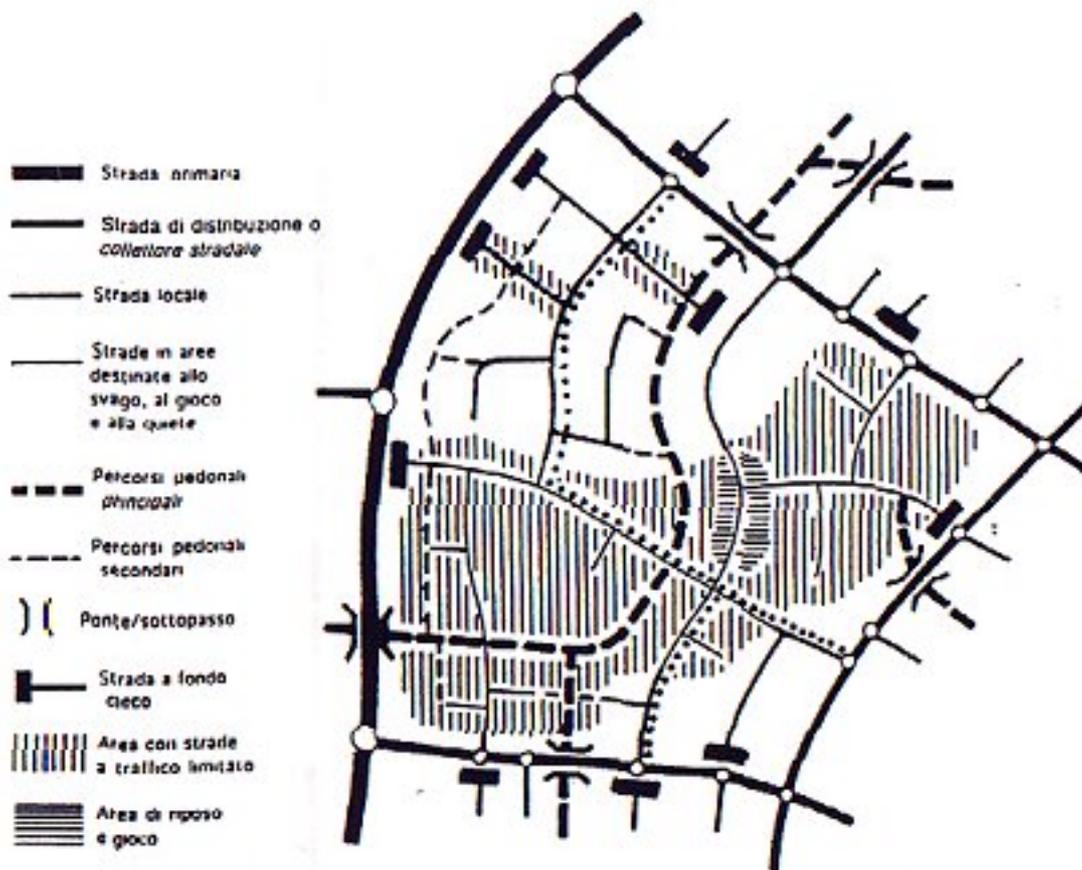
Assetto di rete stradale gerarchicamente strutturato con strade ad andamento curvilineo
